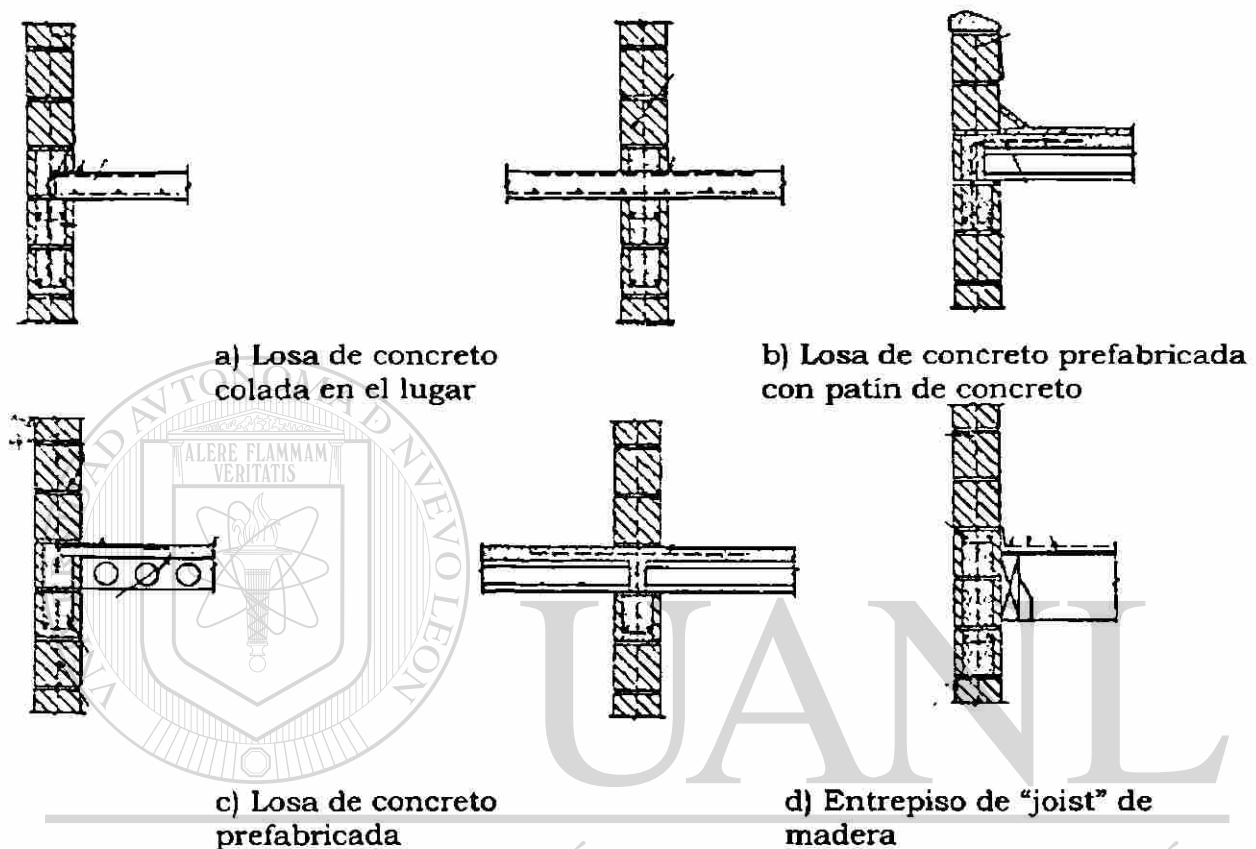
Detalles de conexiones muro-entrepiso, y muro-azotea. [®]
